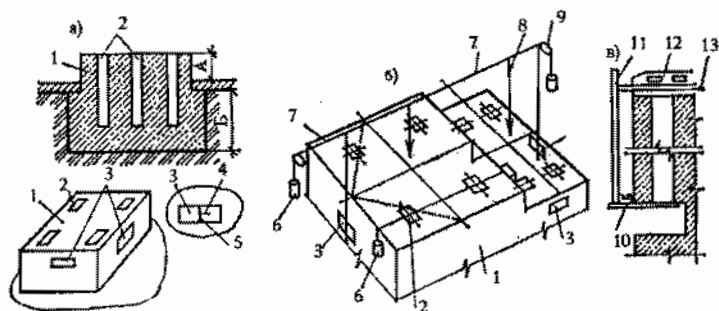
Конструкция фундамента насосного агрегата (а), схема его разметки (б) и проверка глубины колодца (в): 1 - фундамент; 2 - колодцы; 3 - планки; 4 - высотная отметка; 5 - осевая отметка; 6 - груз; 7 - струна; 8 - отвес; 9 - блок; 10 - уровень; 11 - рейка; 12 - проверочная линейка; 13 - отметка низа рамы насоса
